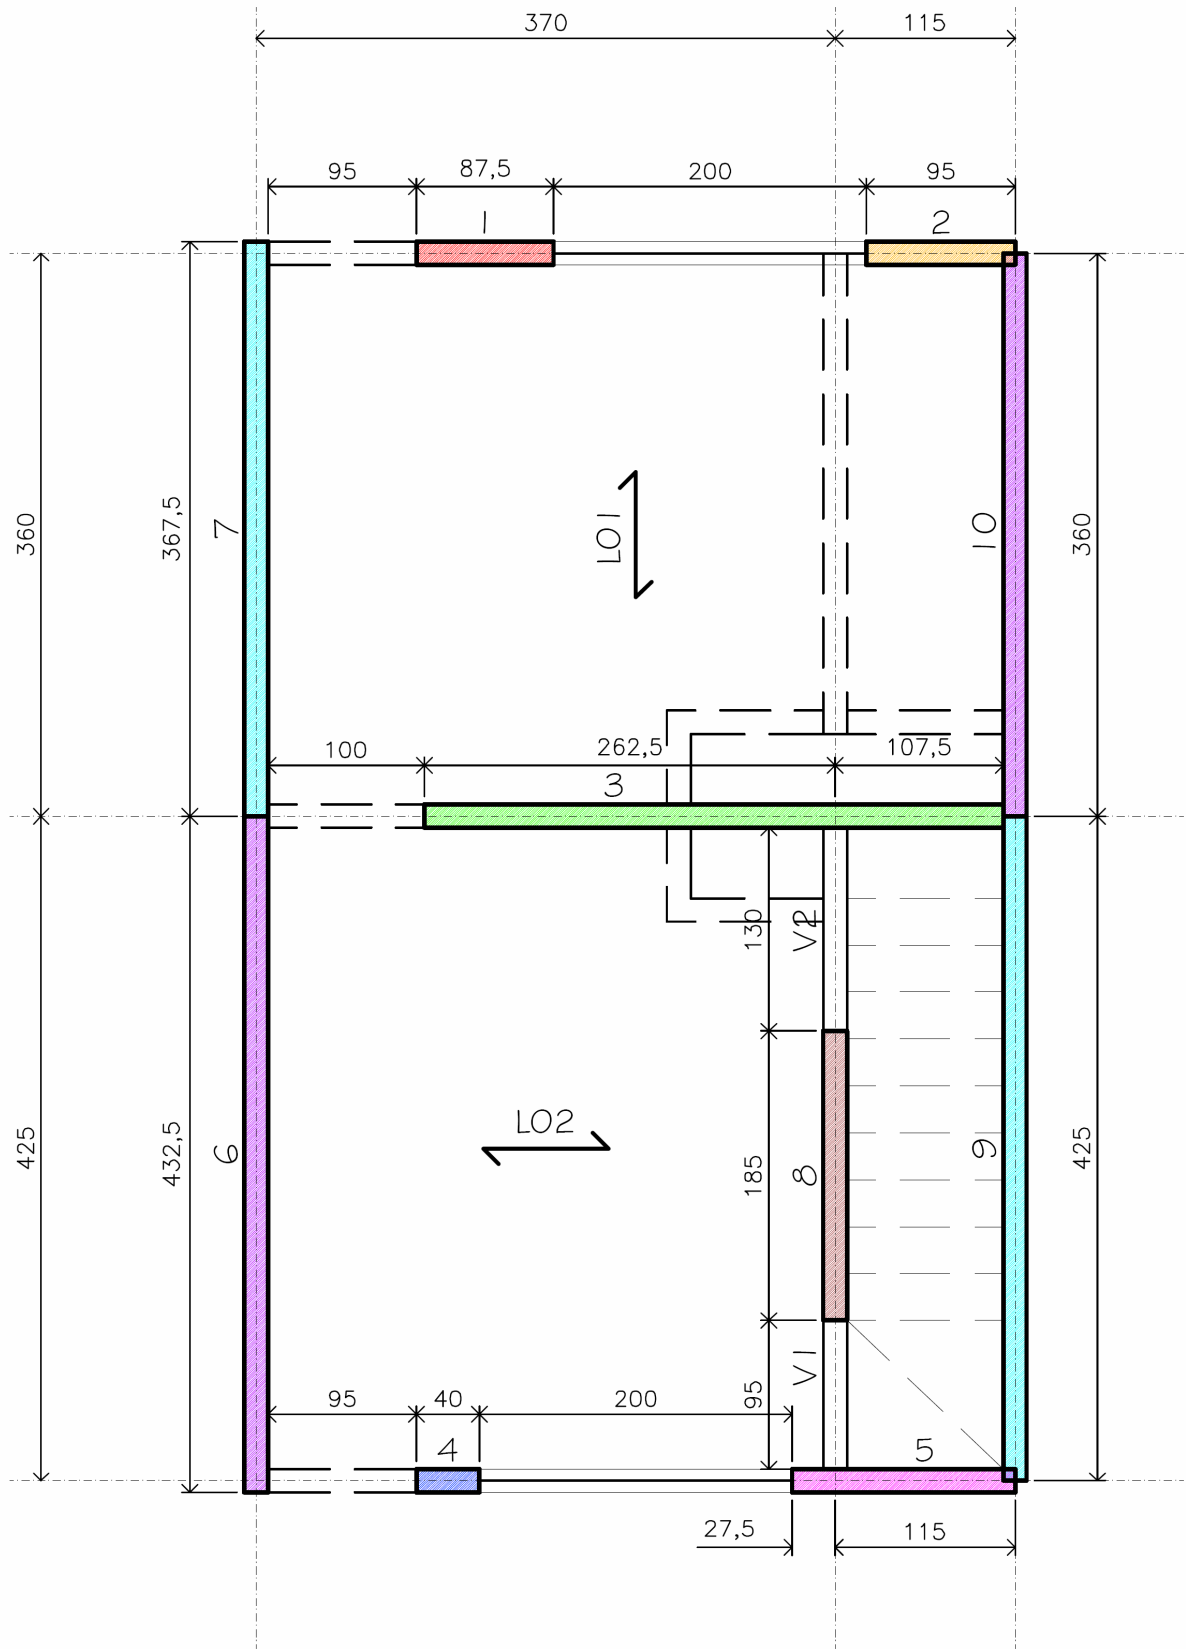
Estrutura do Exemplo J: pavimento inferior
